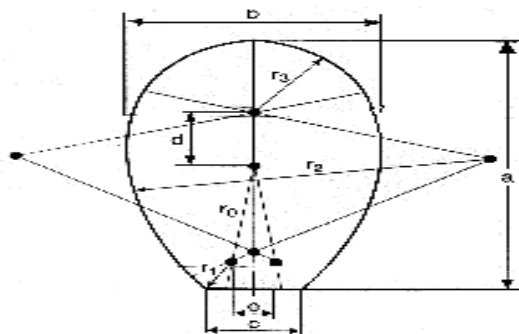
Coupe type d'un tuyau ovoïde préfabriqué
